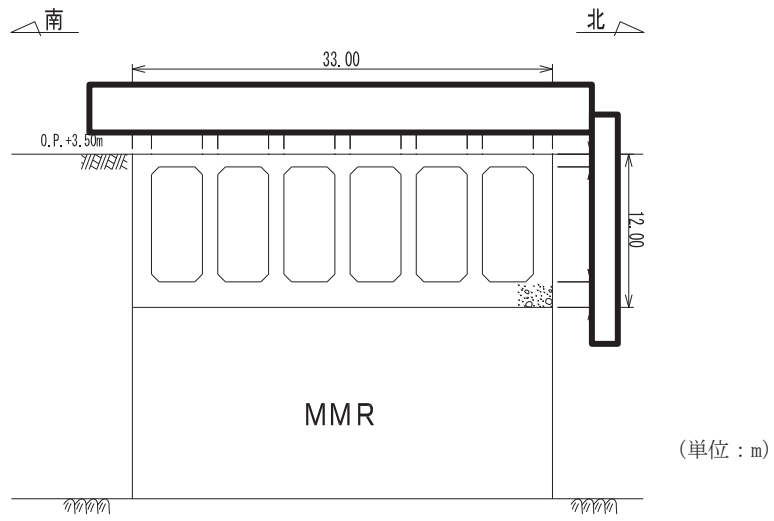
取水口断面図 (A-A 断面, 南北 (標準部))
